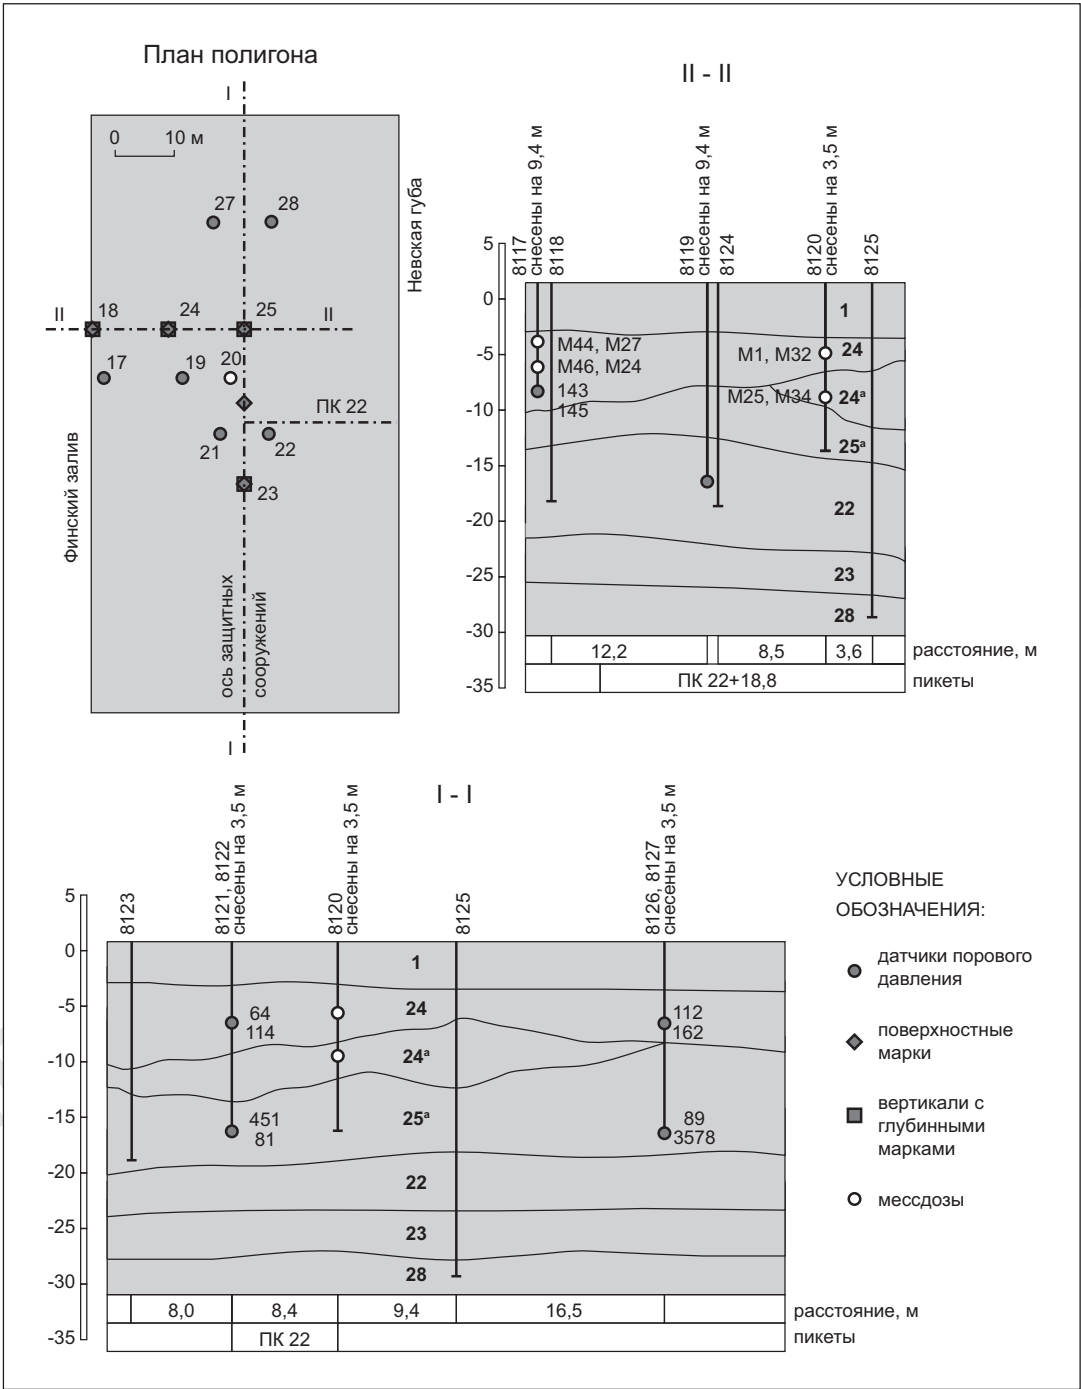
План и разрезы полигона № 1 (на плане в номерах скважин две первые цифры опущены)
